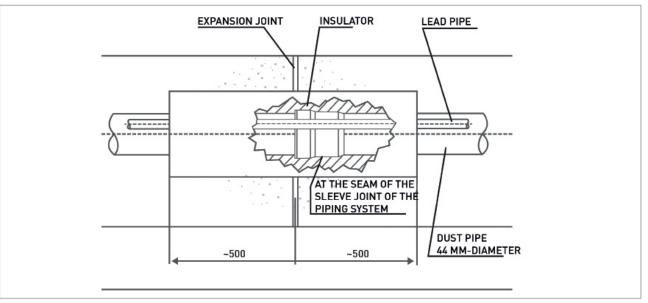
En las estructuras moldeadas, las juntas de dilatación deben aislarse con caucho espumado.
